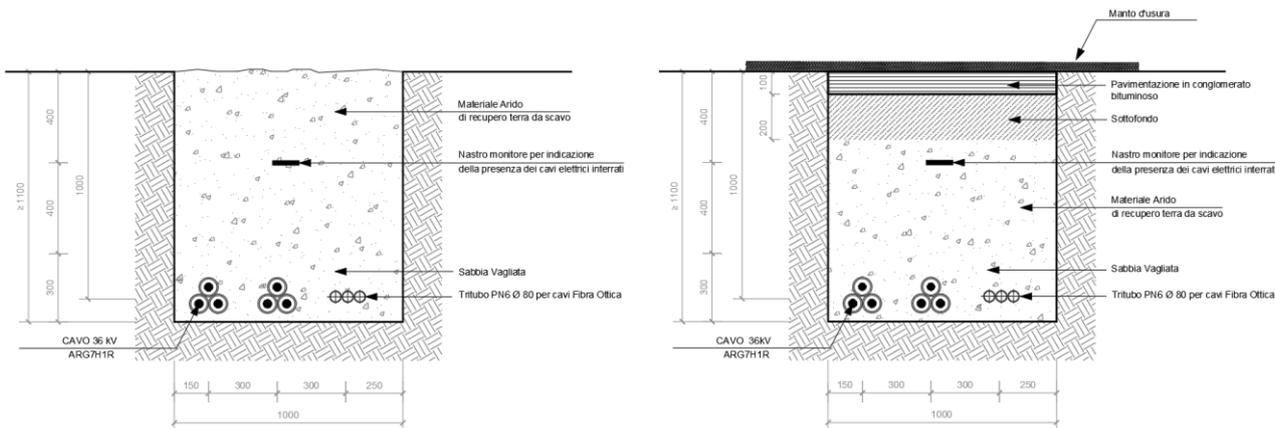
Tipico modalità di posa cavidotto a 36 kV
